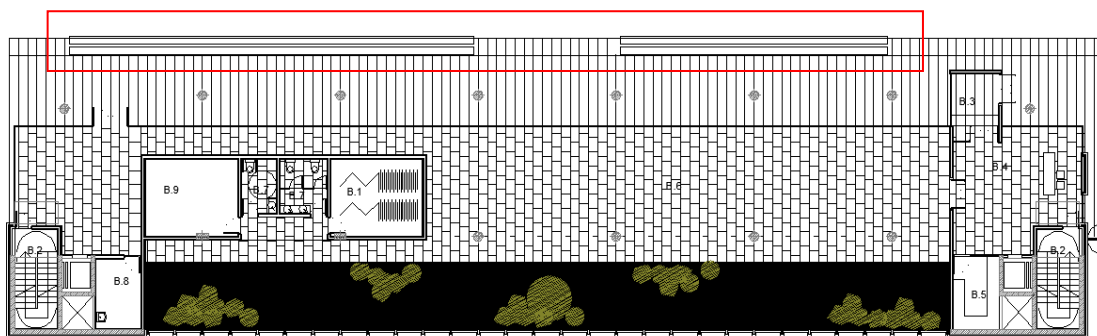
Vista en planta de las rejillas de fachada. Edificio administrativo de Marín.
